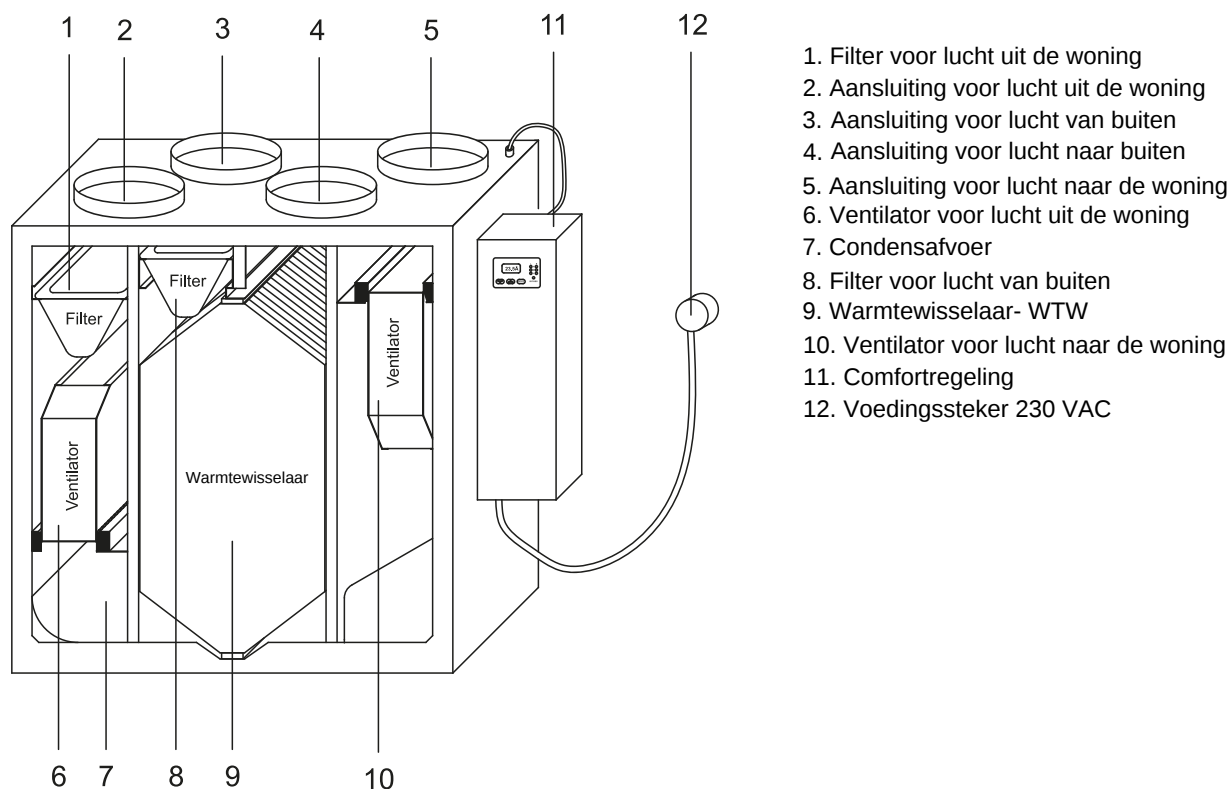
Voor- en bovenaanzicht EuroAir 325 (zonder bypass, rechtse uitvoering)
